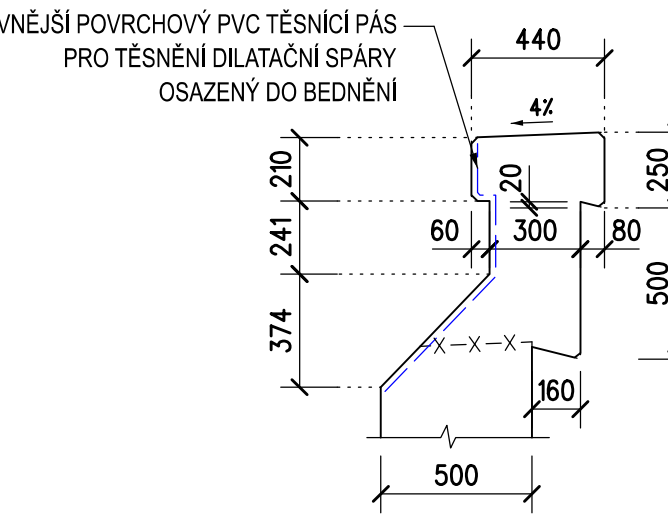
DETAIL II IZOLACE DILATAČNÍ SPÁRY NAD DRENÁŽÍ
